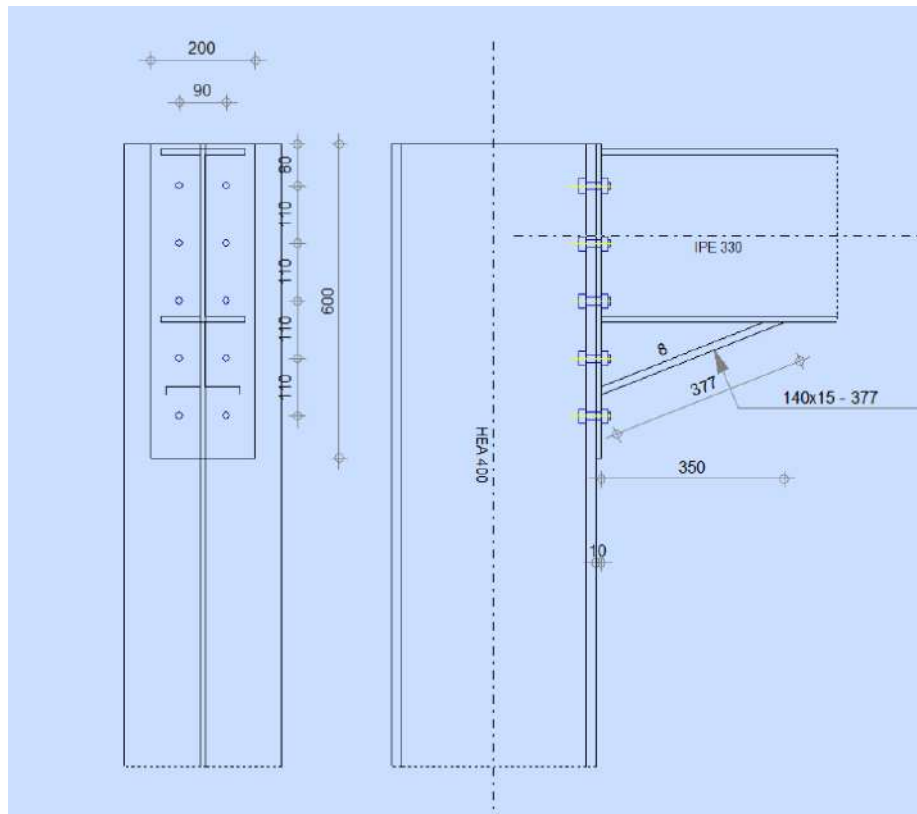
« Schéma d'assemblage poteau-poutre fait par Robot »
